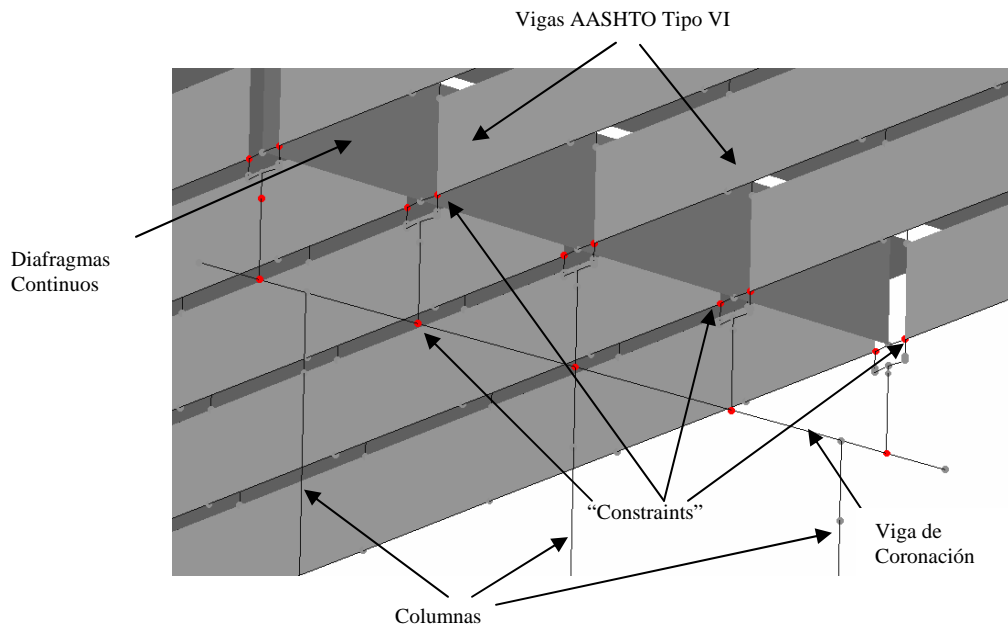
“Constraints” en la viga de coronación y en la base de las vigas AASHTO Tipo VI para las pilastras fijas a la cubierta
